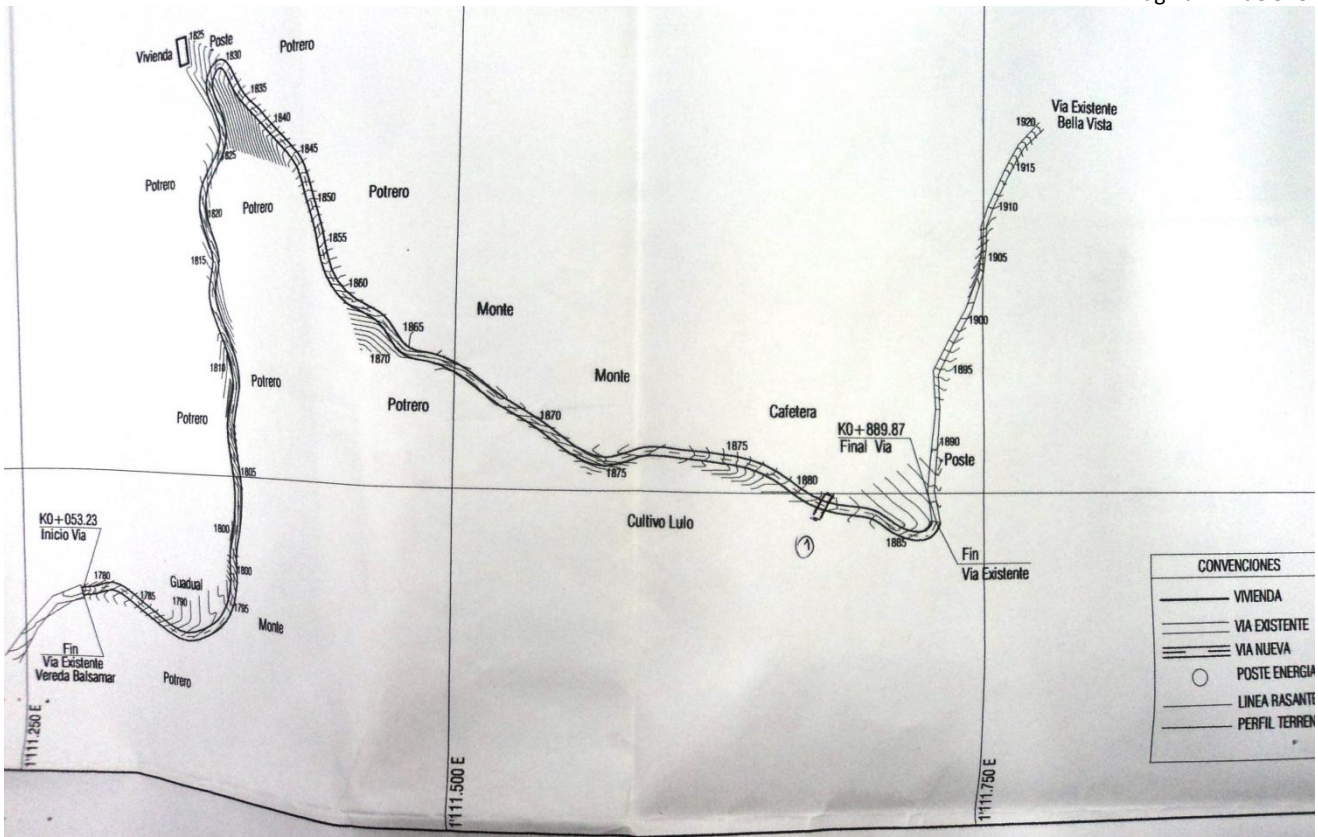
Levantamiento en planta del trazado propuesto de la nueva vía.
